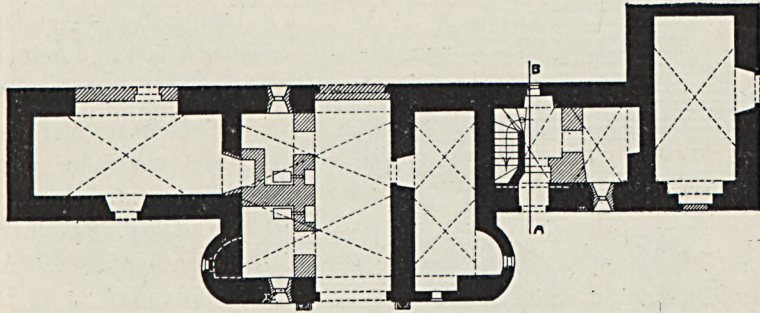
Hainewalde, Schloß, Torhaus, Erdgeschoß.
